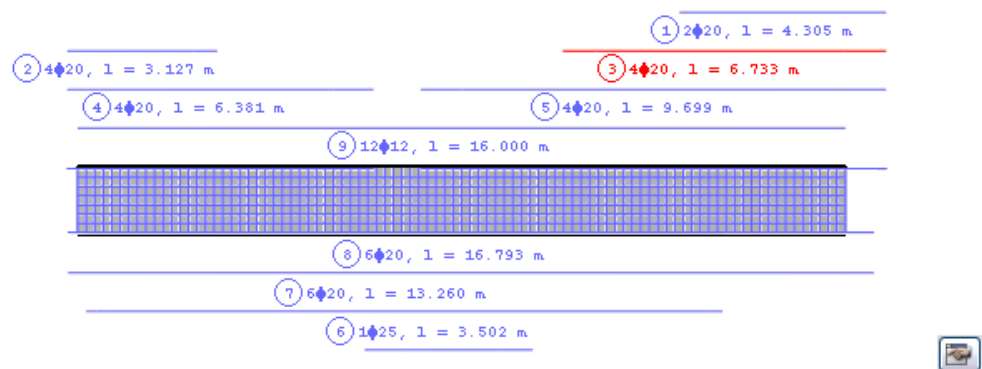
Bewehrungsskizze in Maske 3.1 *Vorhandene Bewehrung
